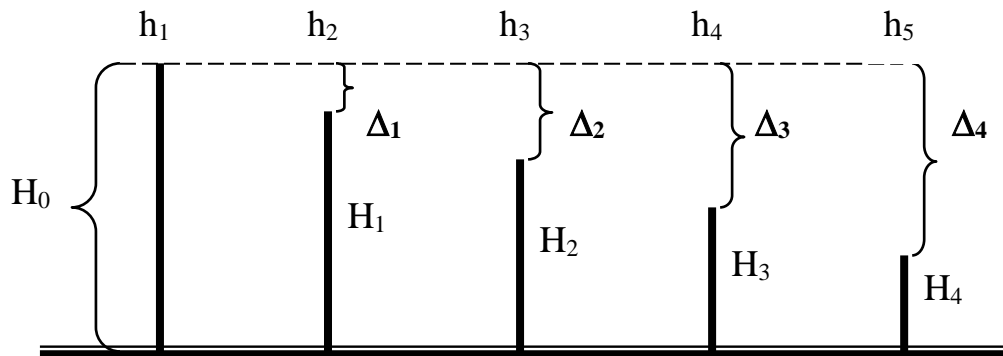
Схема розрахунку стійок для кріплення трубопроводу
